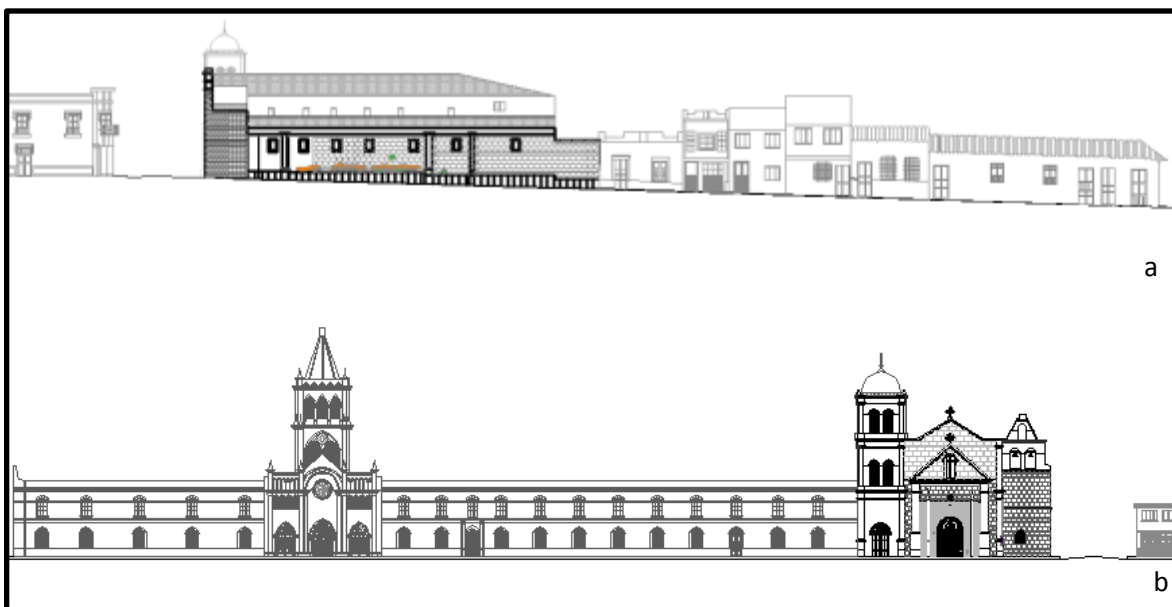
En imagen se muestra a. Fachada manzana sobre la carrera 7ª y b. Fachada sobre la calle 5ª.
